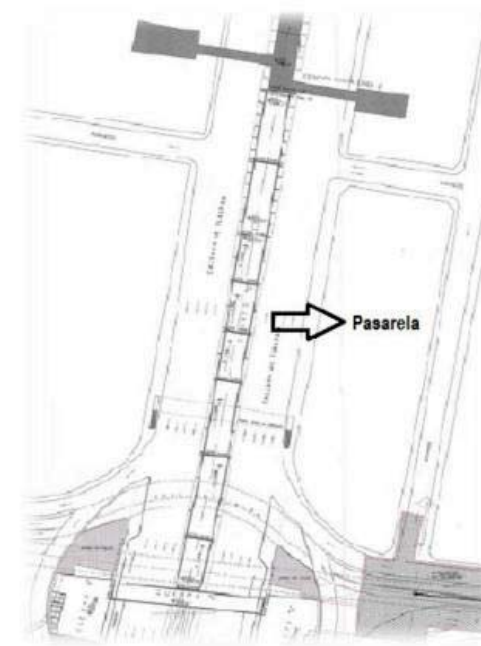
Planta de Conjunto arquitectónico. Pasarela
